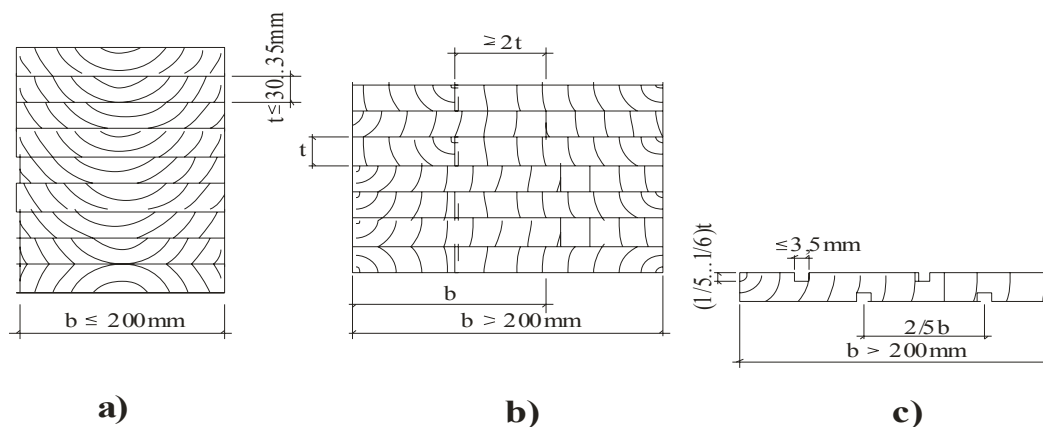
Modul de realizare în secțiune transversală a elementelor din lemn încheiat
